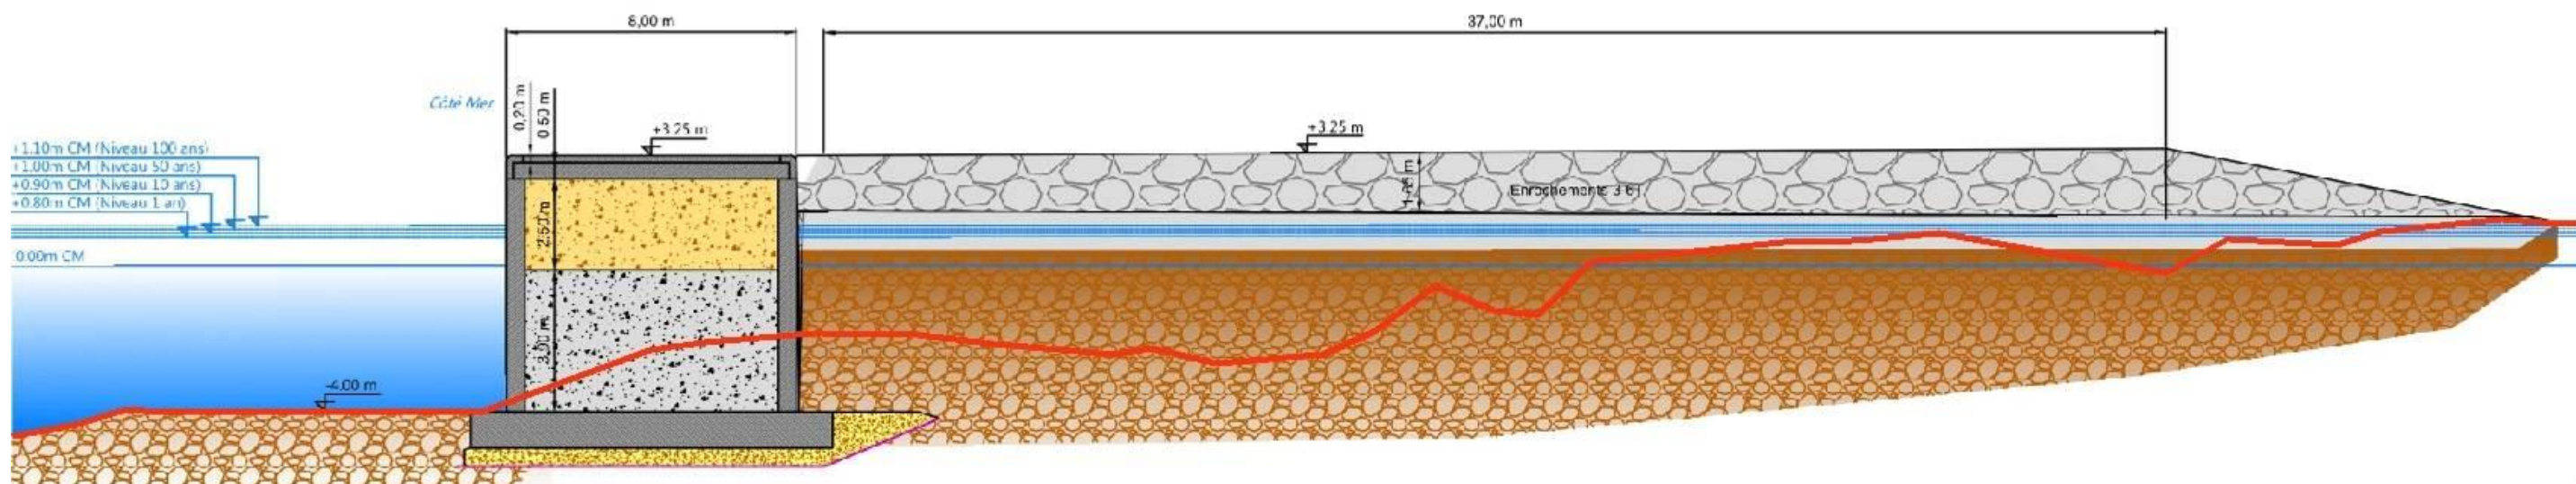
Tenon Ouest et digue solution caisson poids – Coupe 1 - — : Profil du terrain actuel
